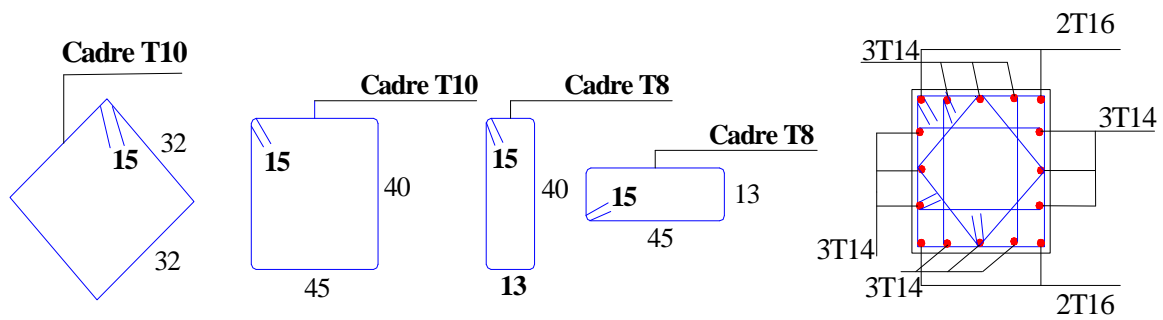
Schéma de ferrailage des poteaux étage 01, 02, 03 et 04
